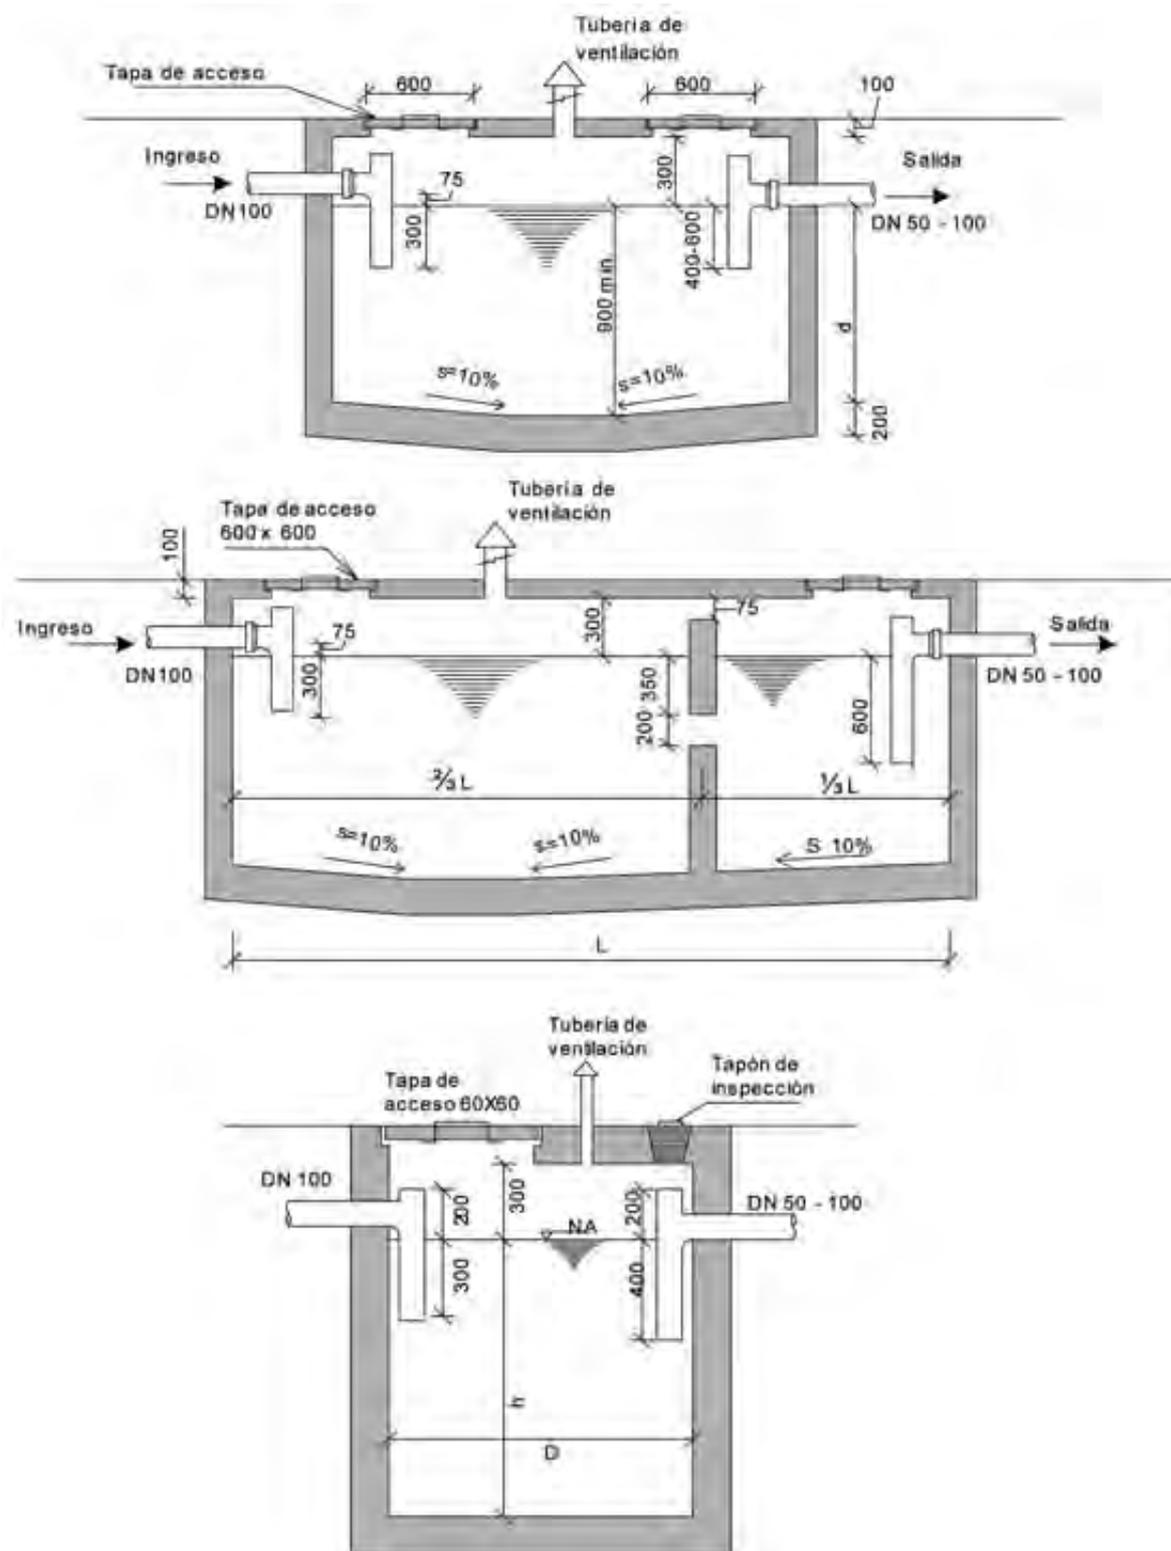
Detalles constructivos. Tanques sépticos típicos
